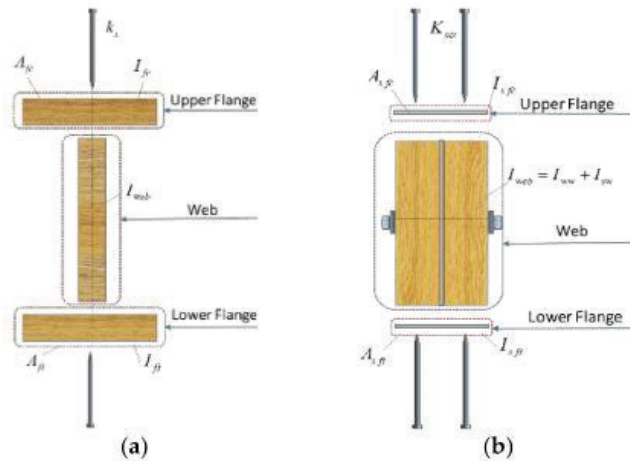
(a) Poutre Bois ; (b) poutre acier – bois [TSA 2018]
